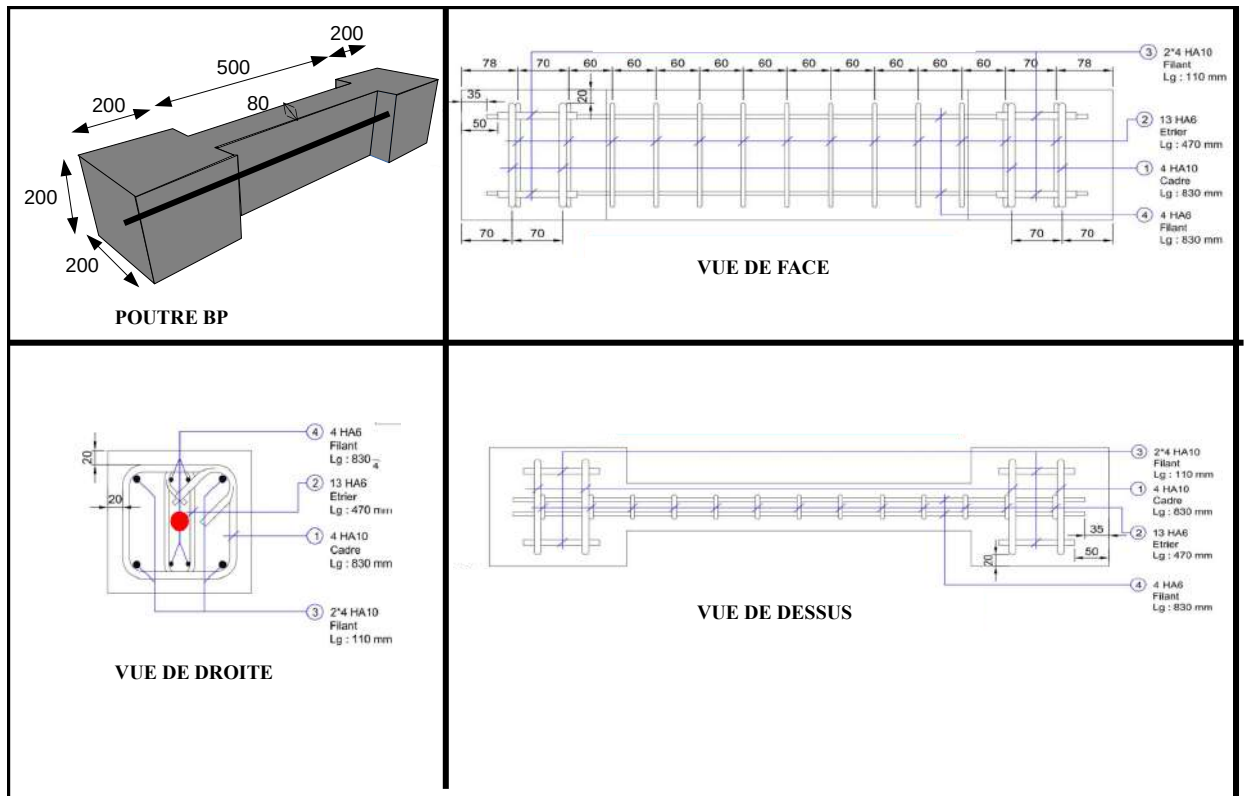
Plan de ferrailage des poutres en BP explicité via trois coupes, avec cotations en mm
